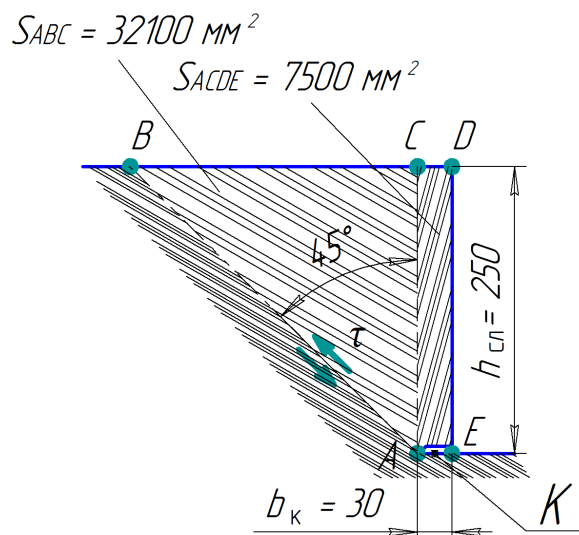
К определению сечения грунта, воздействующего на переднюю фаску консольного ножа
